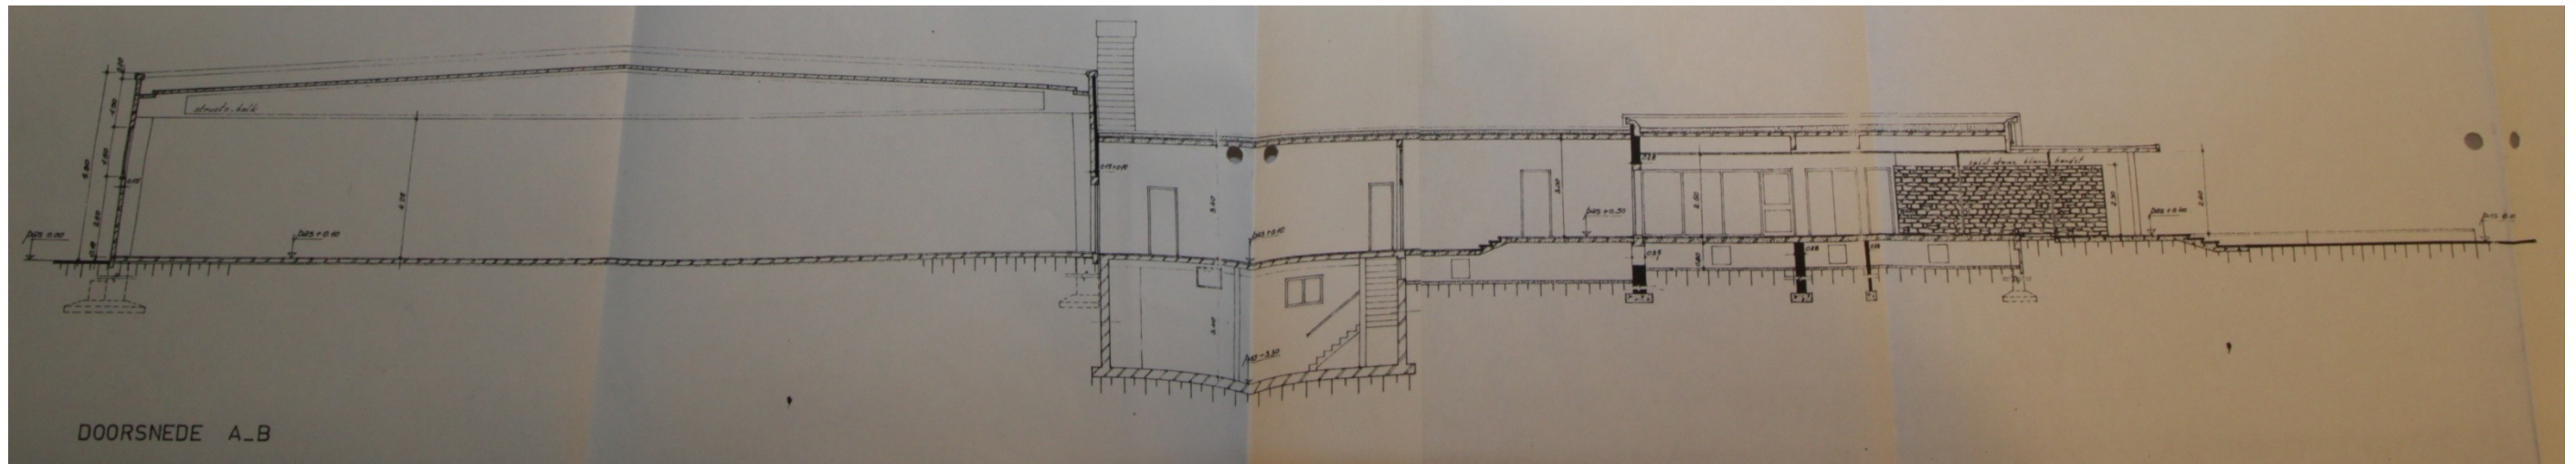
Doorsnede A-B van de plannen uit 1964 (architect Paul M. Tombeur).
